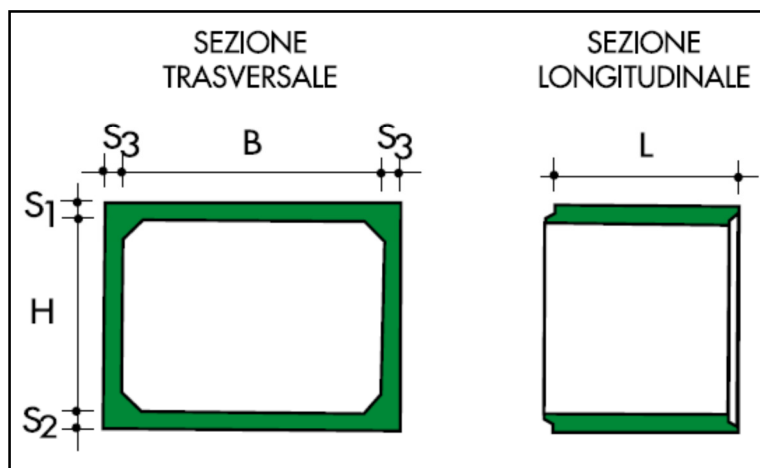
Sezione tipo dello scatolare in c.a.
